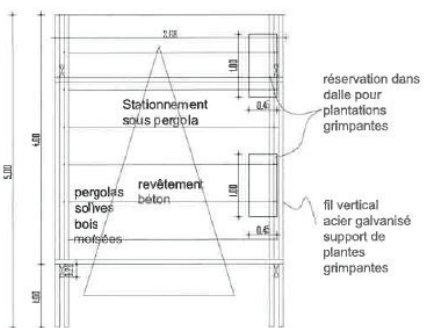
Exemple constructif (document non contractuel) dans le cas d'une construction d'une pergola (vue en plan)
